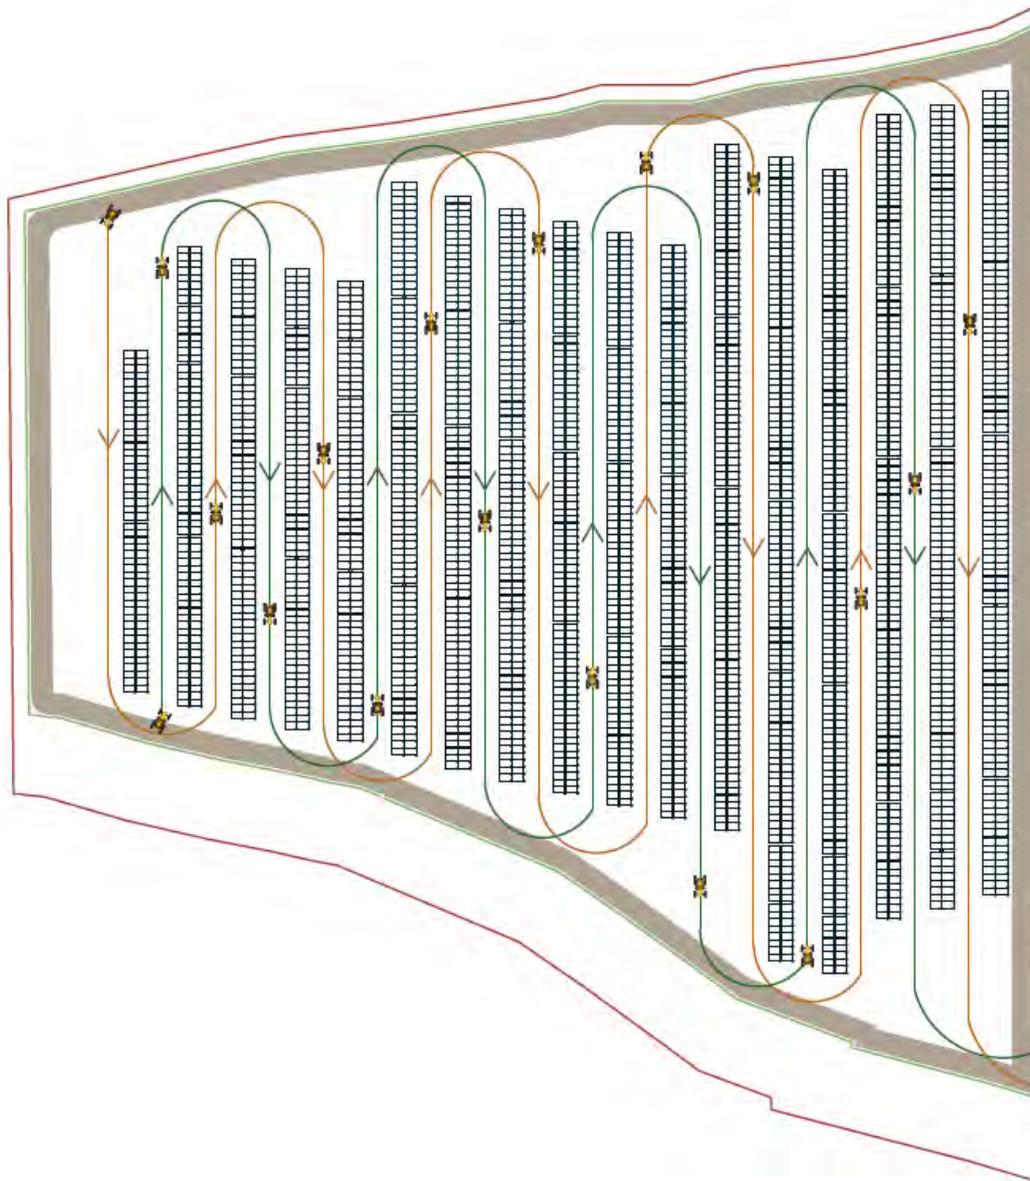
Particolare delle lavorazioni su file alternate (planimetria).
